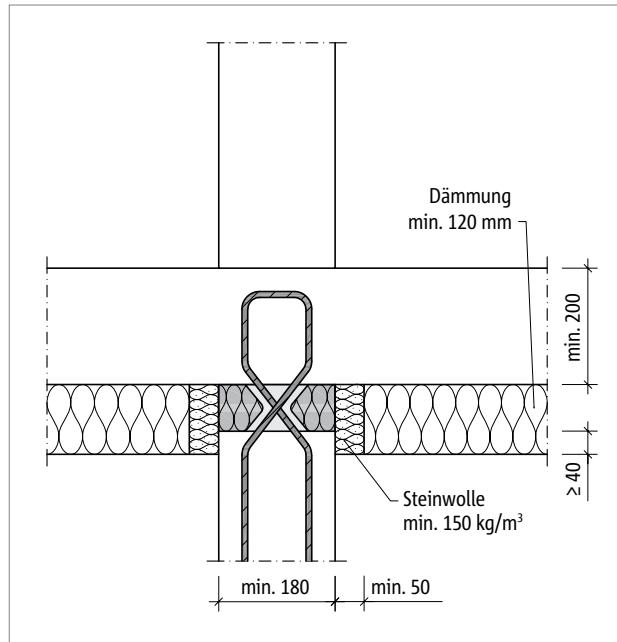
Schöck Sconnex® Typ W: Mit Brandschutzstreifen aus Steinwolle im Bereich der Unterdeckendämmung
